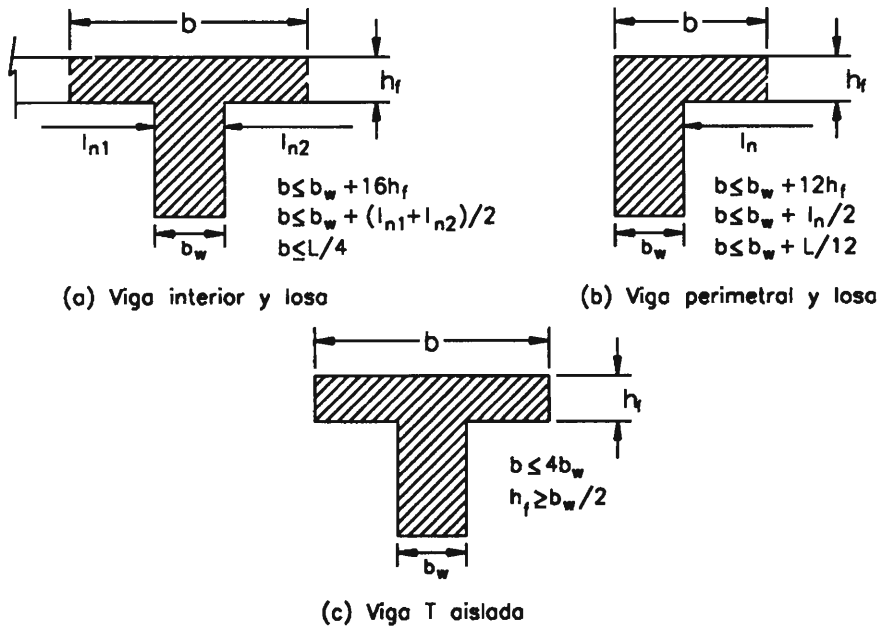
Propuestas del código del ACI para la estimación del ancho efectivo de losa que contribuye a la resistencia a la flexión de la viga
